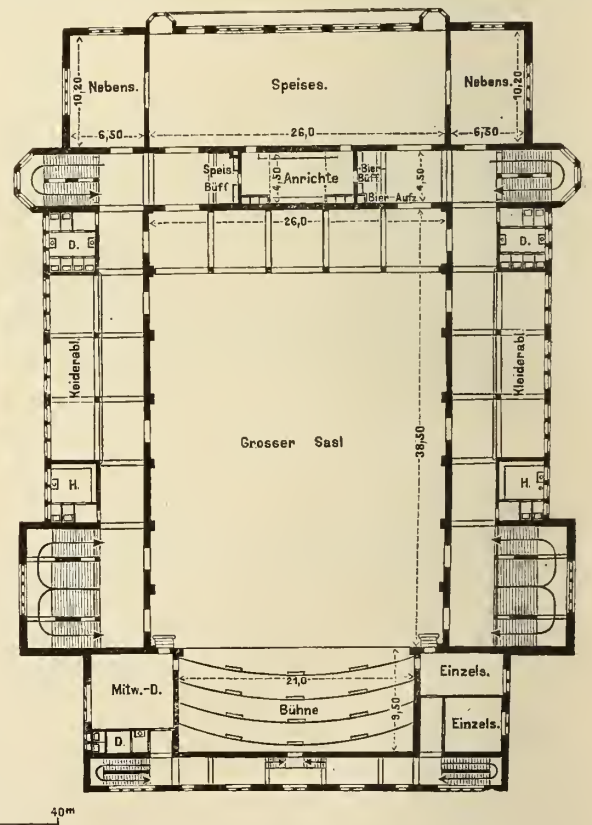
Grundriss vom Hauptgeschoss.
